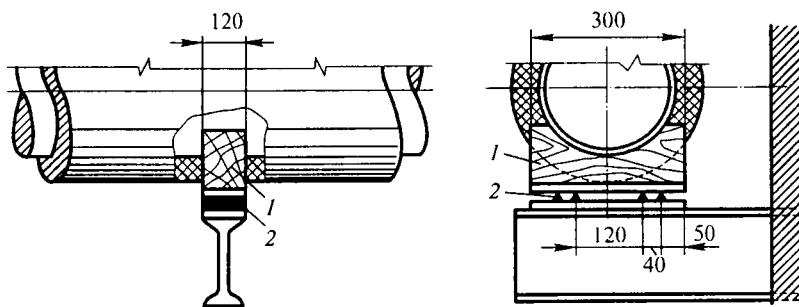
Схема крепления трубопровода к стене на кронштейне:
